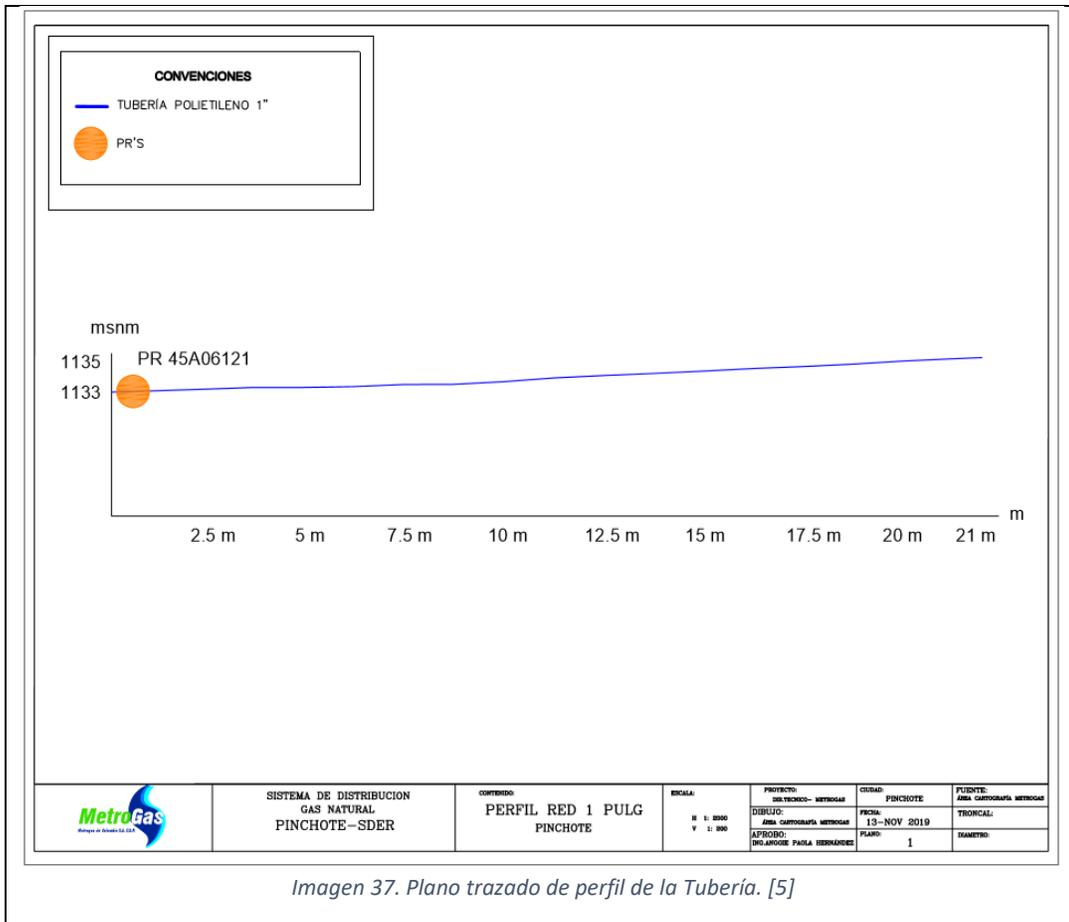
Plano trazado de perfil de la Tubería. [5]
